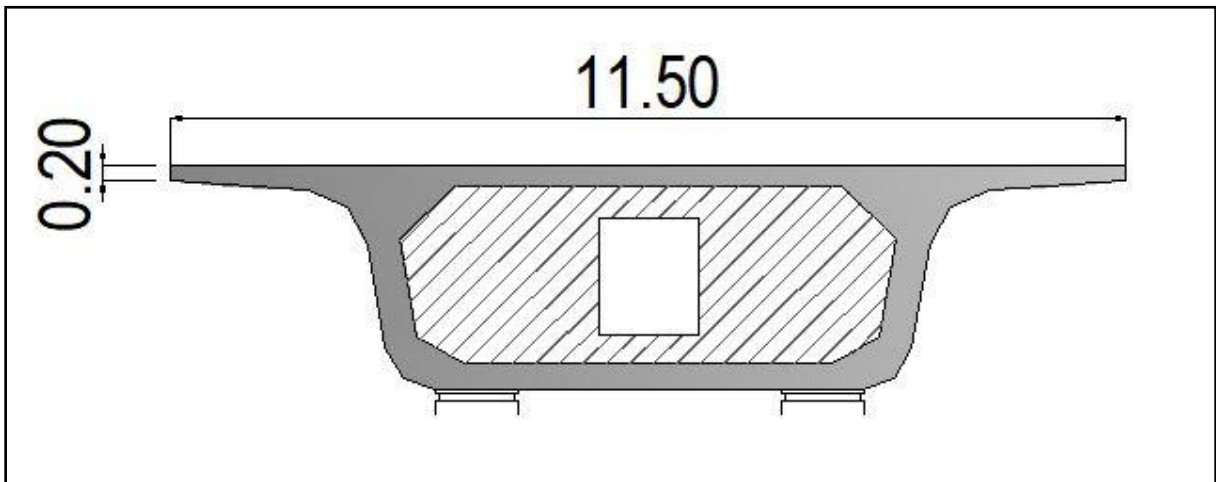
Coupe transversale de voussoir sur la pile variante 2
